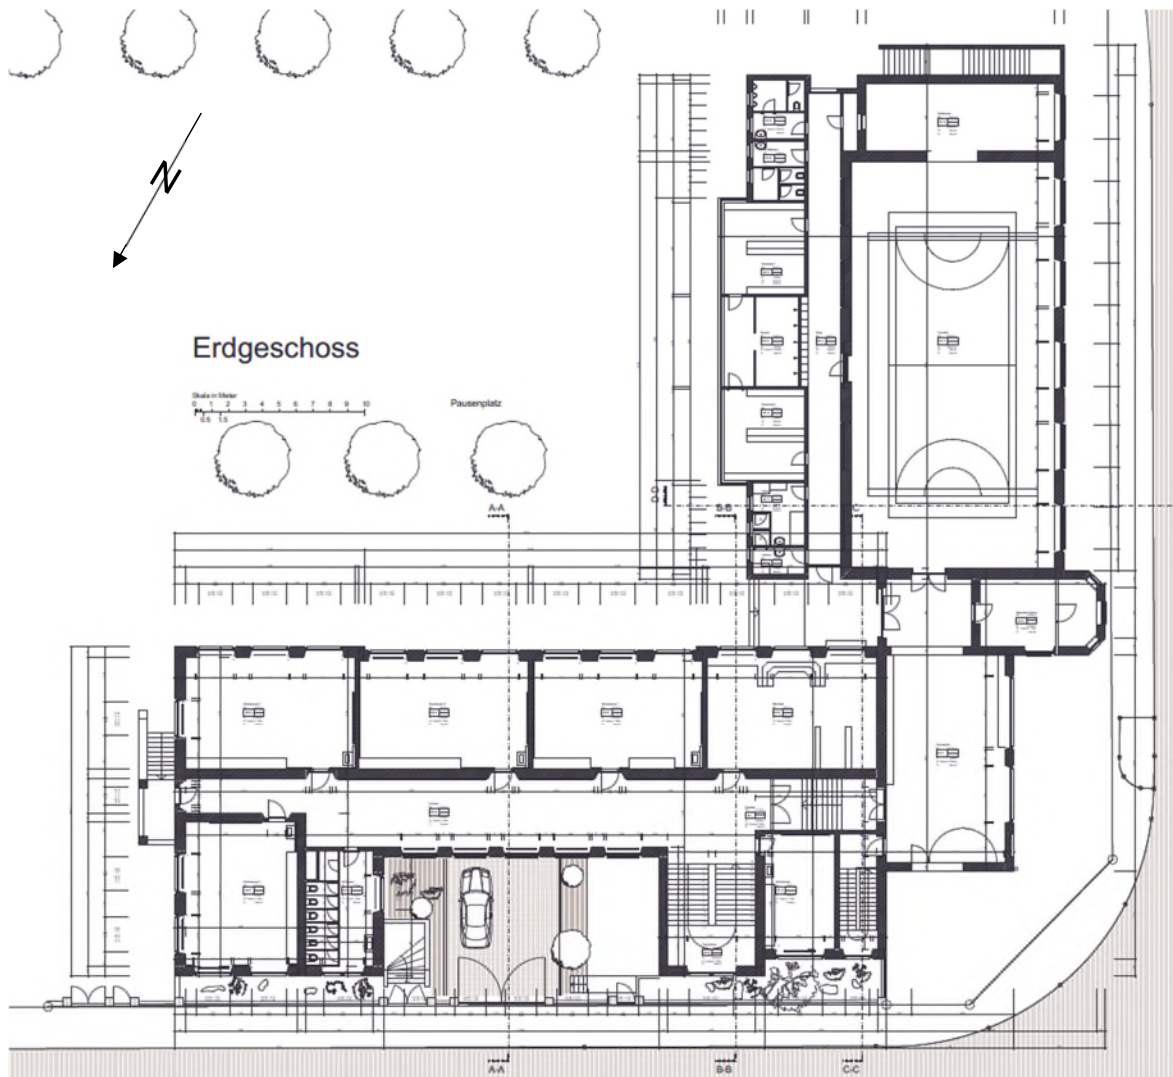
Schulanlage Moosmatt, Grundriss Erdgeschoss
